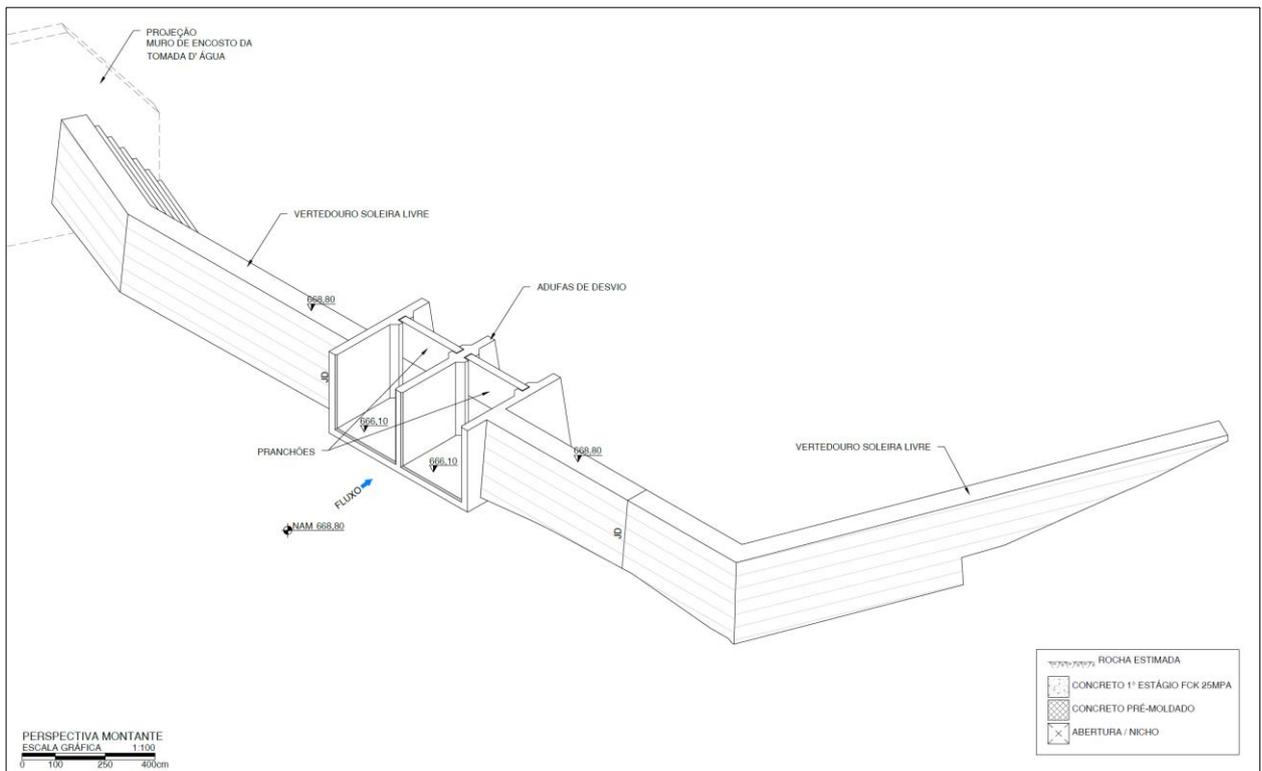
Perspectiva Barragem Vertente CGH Teles de Proença – Vista de Montante
